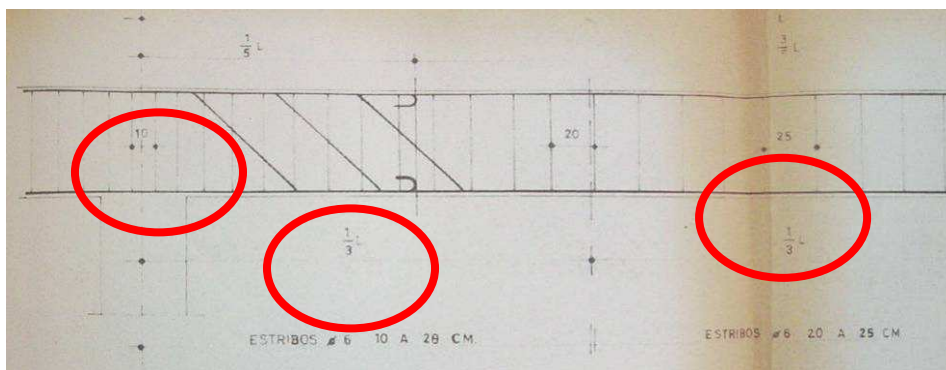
Detalle de la separación de estribos. Edificio ficha 186^a.009, 1968
